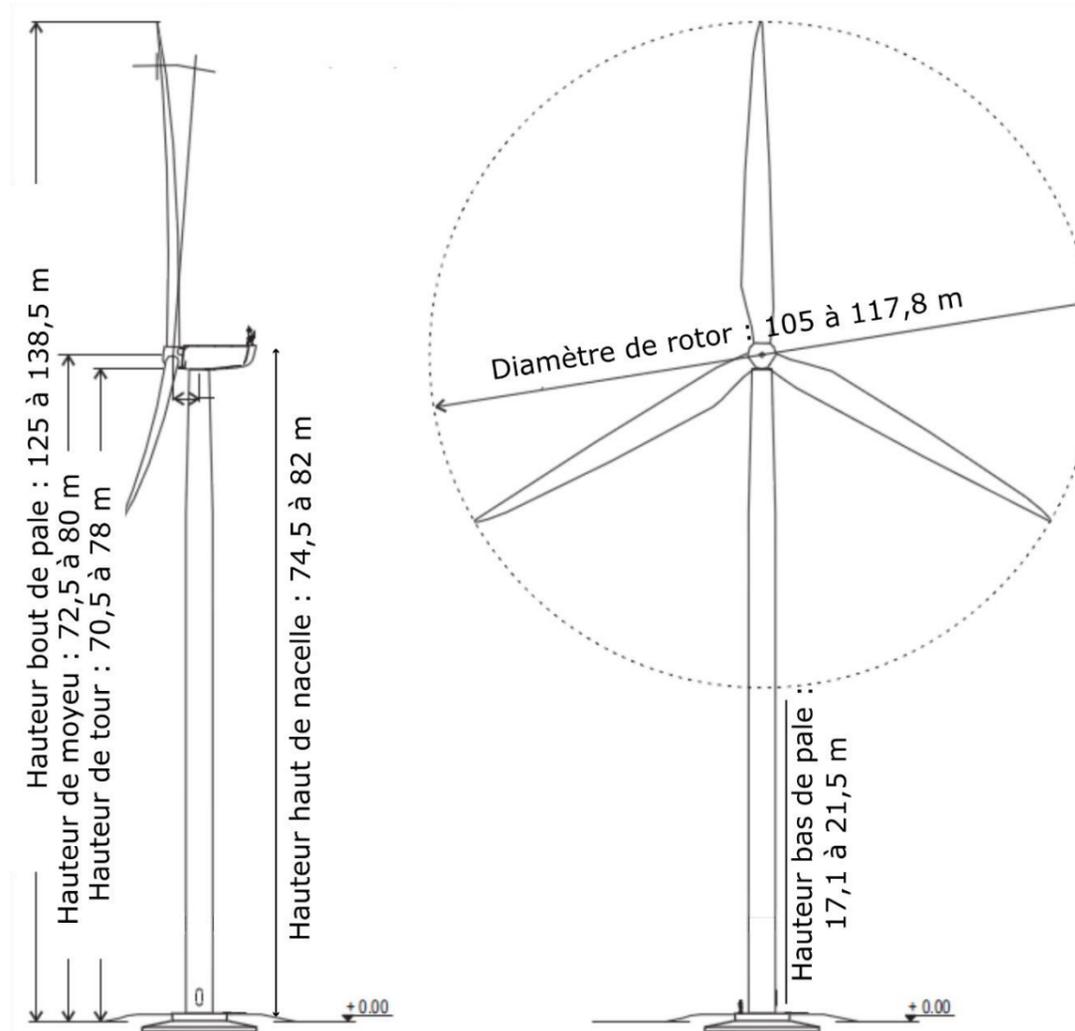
Plan d'élevation du gabarit-type d'éolienne prévu
